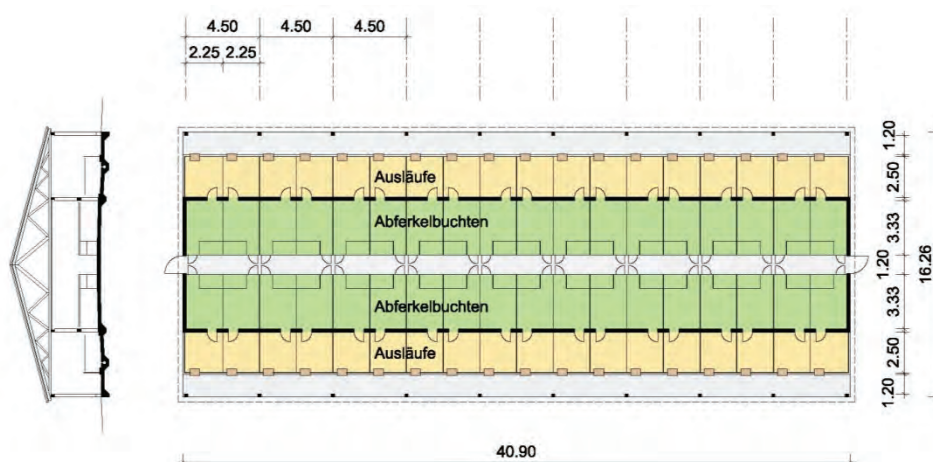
Grundriss, Ansichten und Schnitt des Abferkelstallabteils mit außenliegender Fütterung
